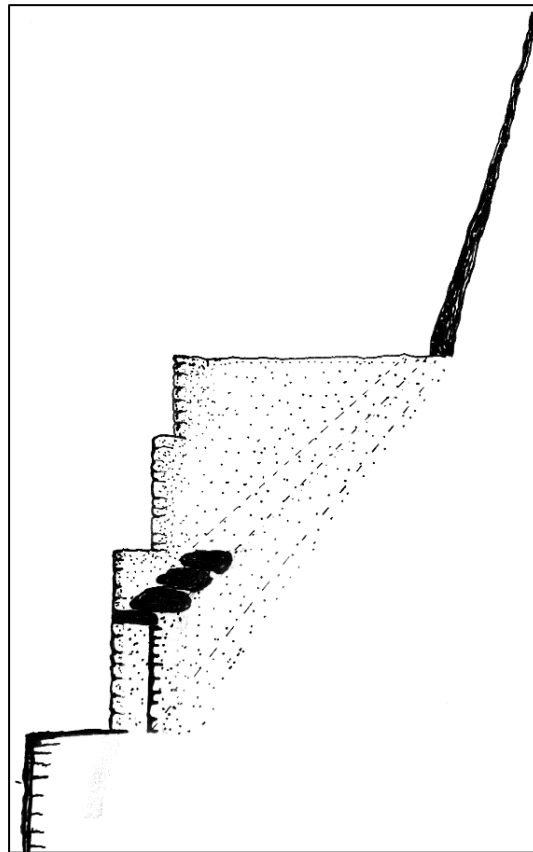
Croquis del corte transversal como se refleja en la foto y croquis donde sobre la alcantarilla pasa la plataforma del camino.
